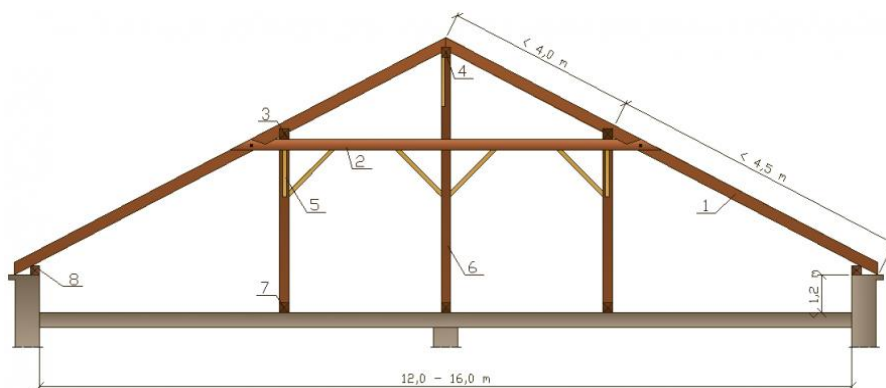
Dach w konstrukcji jętkowej: 1 - krokiew, 2 - jętka, 3 - murlata, 4 - wieniec żelbetowy, 5 - wiatrownice [5]
